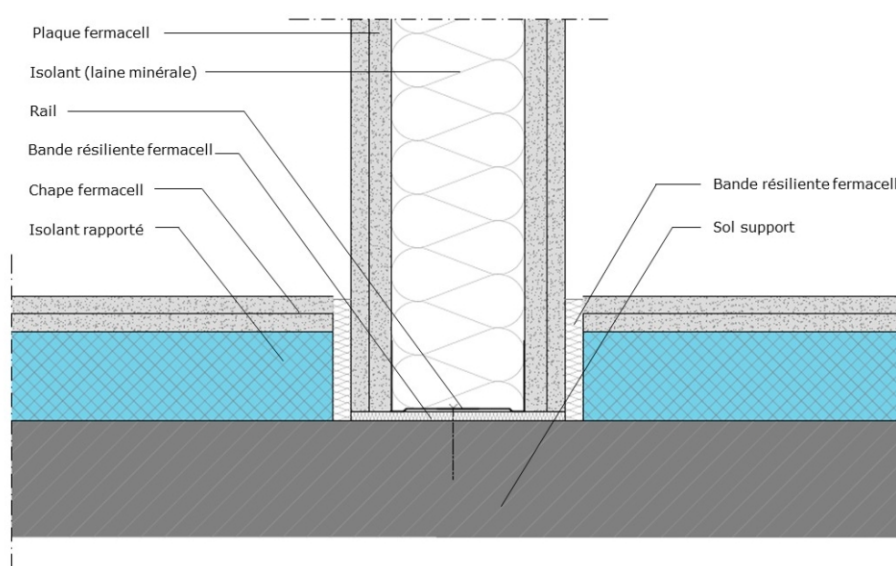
Cloison séparative (parement double) sur plancher porteur
